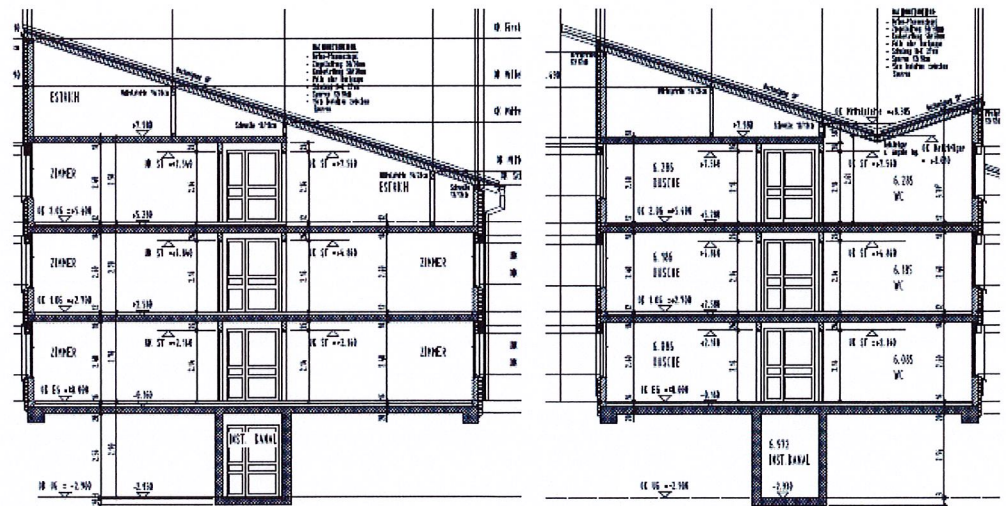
Schnitt durch Block 7 und Schnitt Übergangsbereich Block 6-7, Gebäude WG
